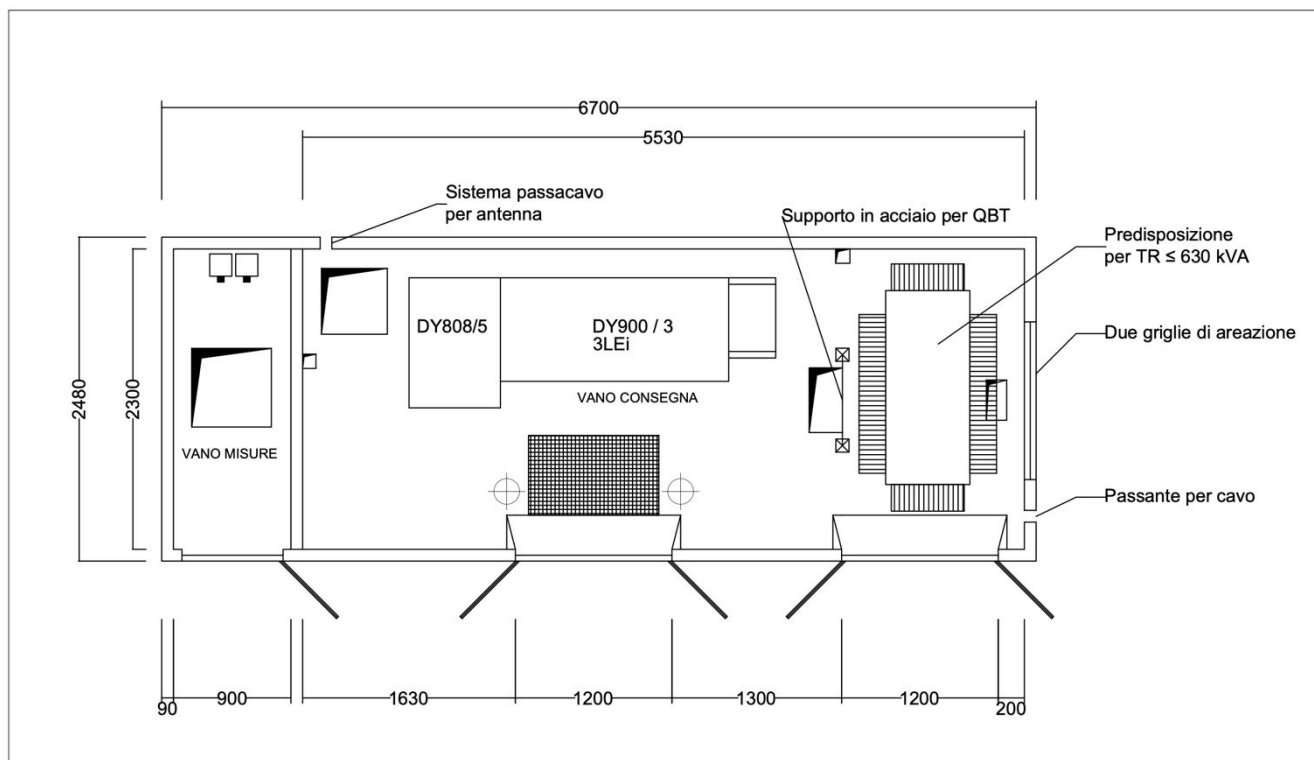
Planimetria del locale gestore di rete e del vano misure della cabina di consegna secondo DG 2061 ed. 9
